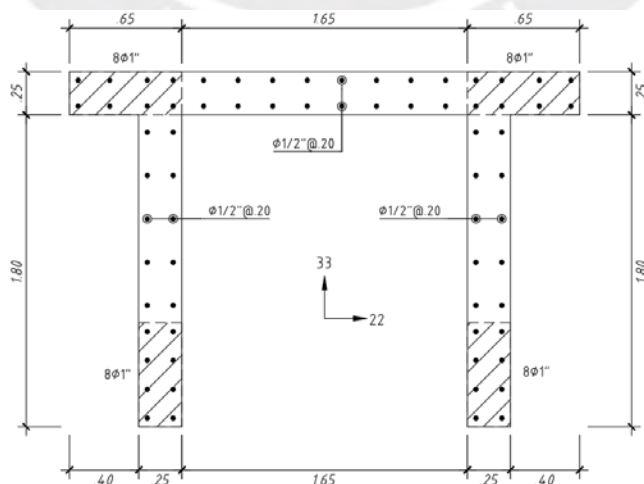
Detalle de refuerzo a flexo-compresión de la placa PL-02.
